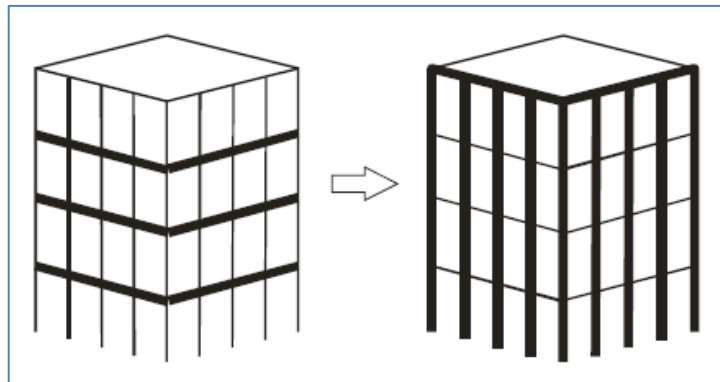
El sistema columna fuerte viga débil es mejor al contrario.
